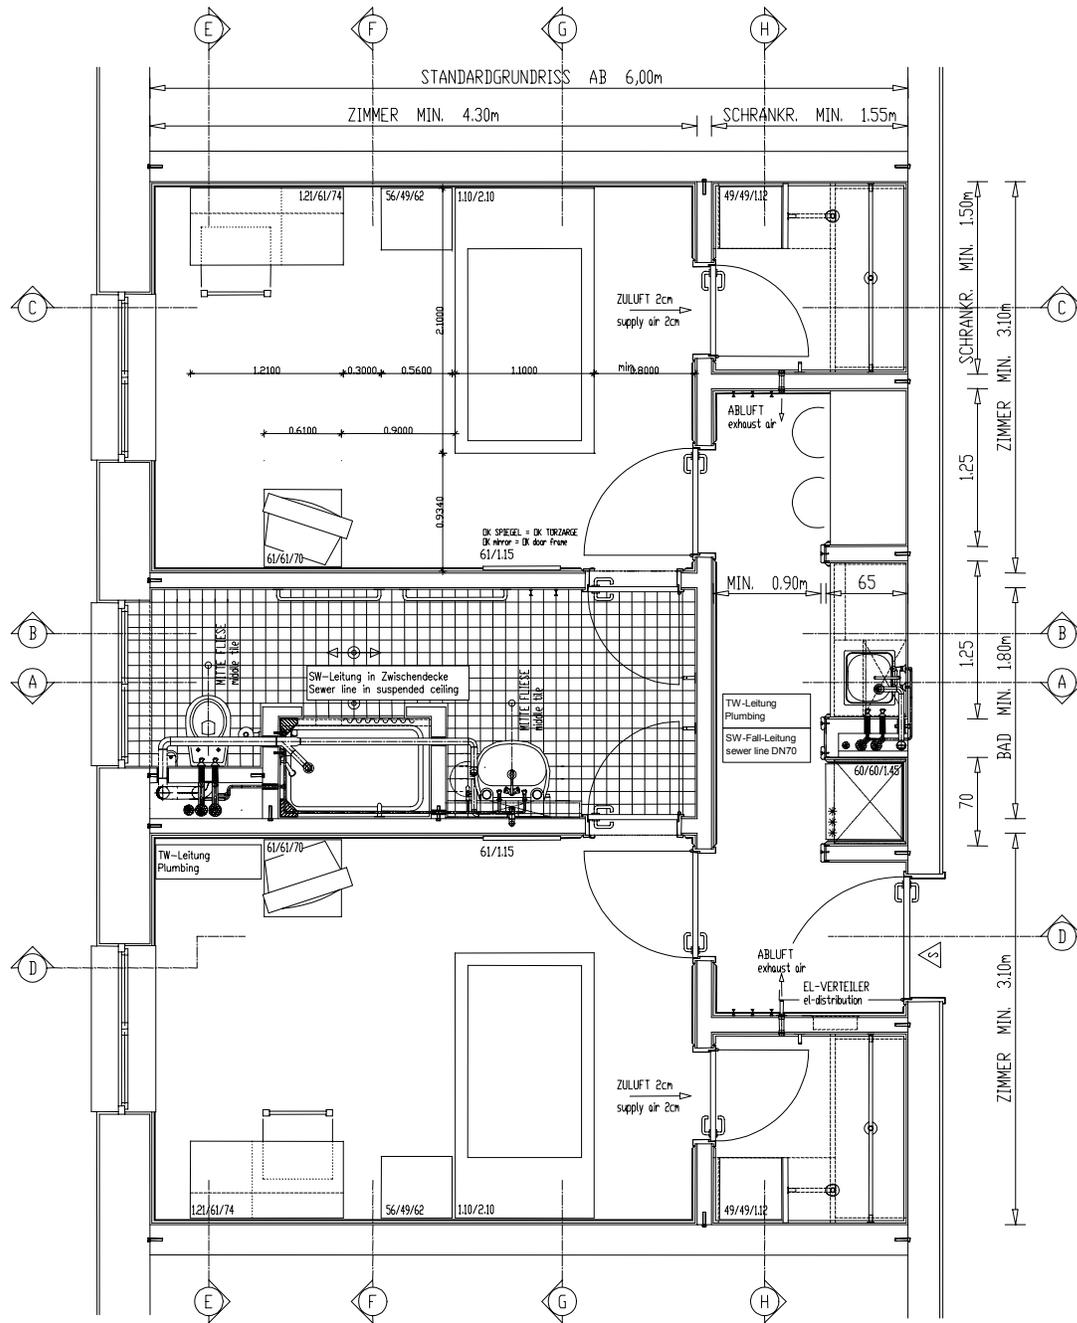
2 Beispielgrundriss Typ 2
